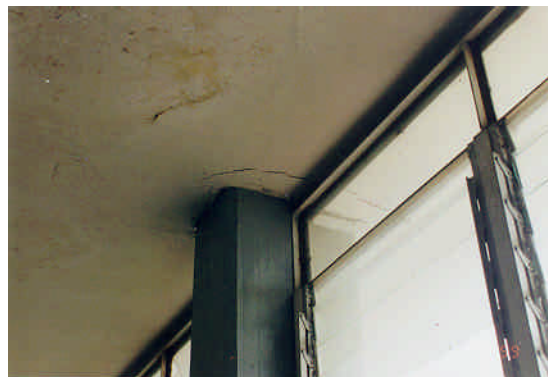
y 7.18 - Detalle del daño en una columna del cuerpo C (fachada sur)
